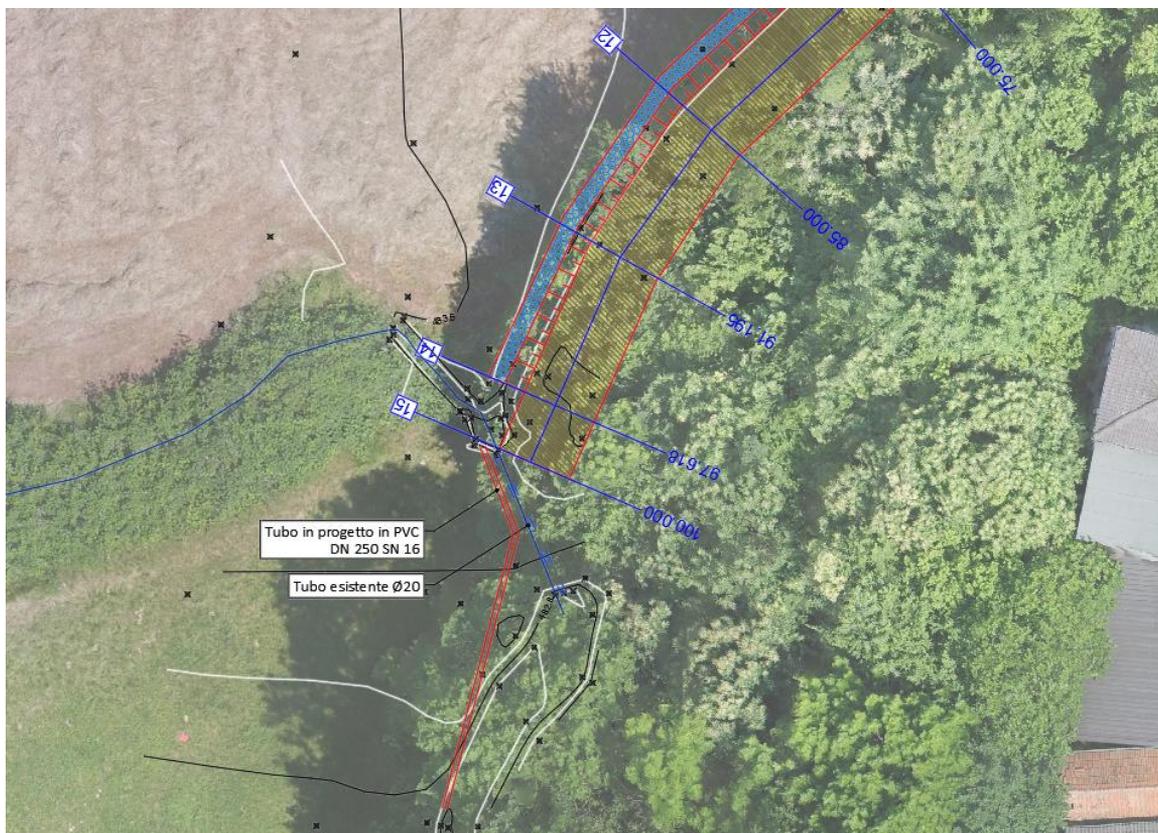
Estratto "Tav.03 – Planimetria di progetto"
